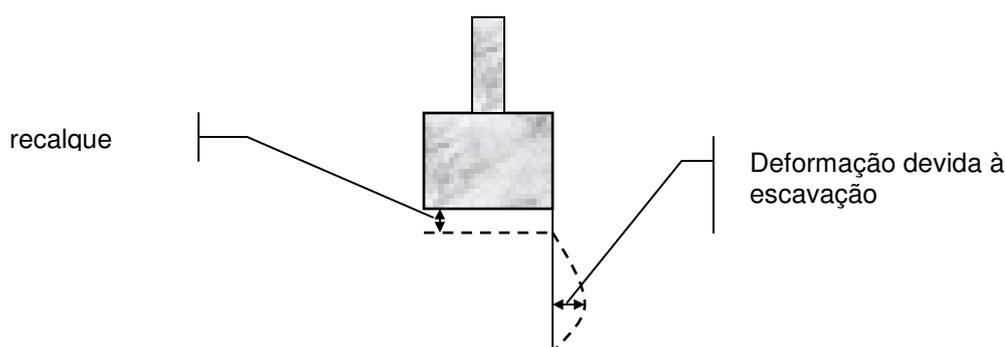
Recalque de fundação proveniente da deformação do solo devido à escavação (DAL MOLIN, 1988).
